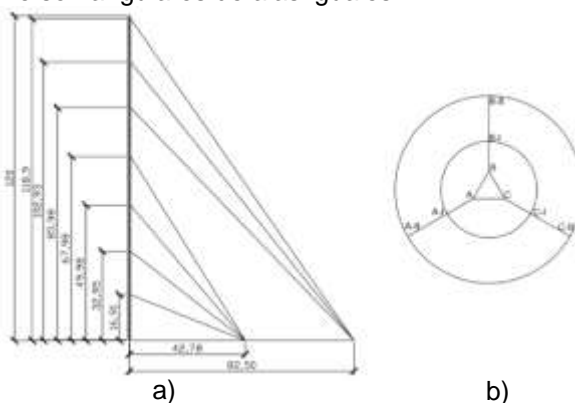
a) Elevación de la torre MAR-2008 b) Planta de la estructura del modelo MAR-2008
